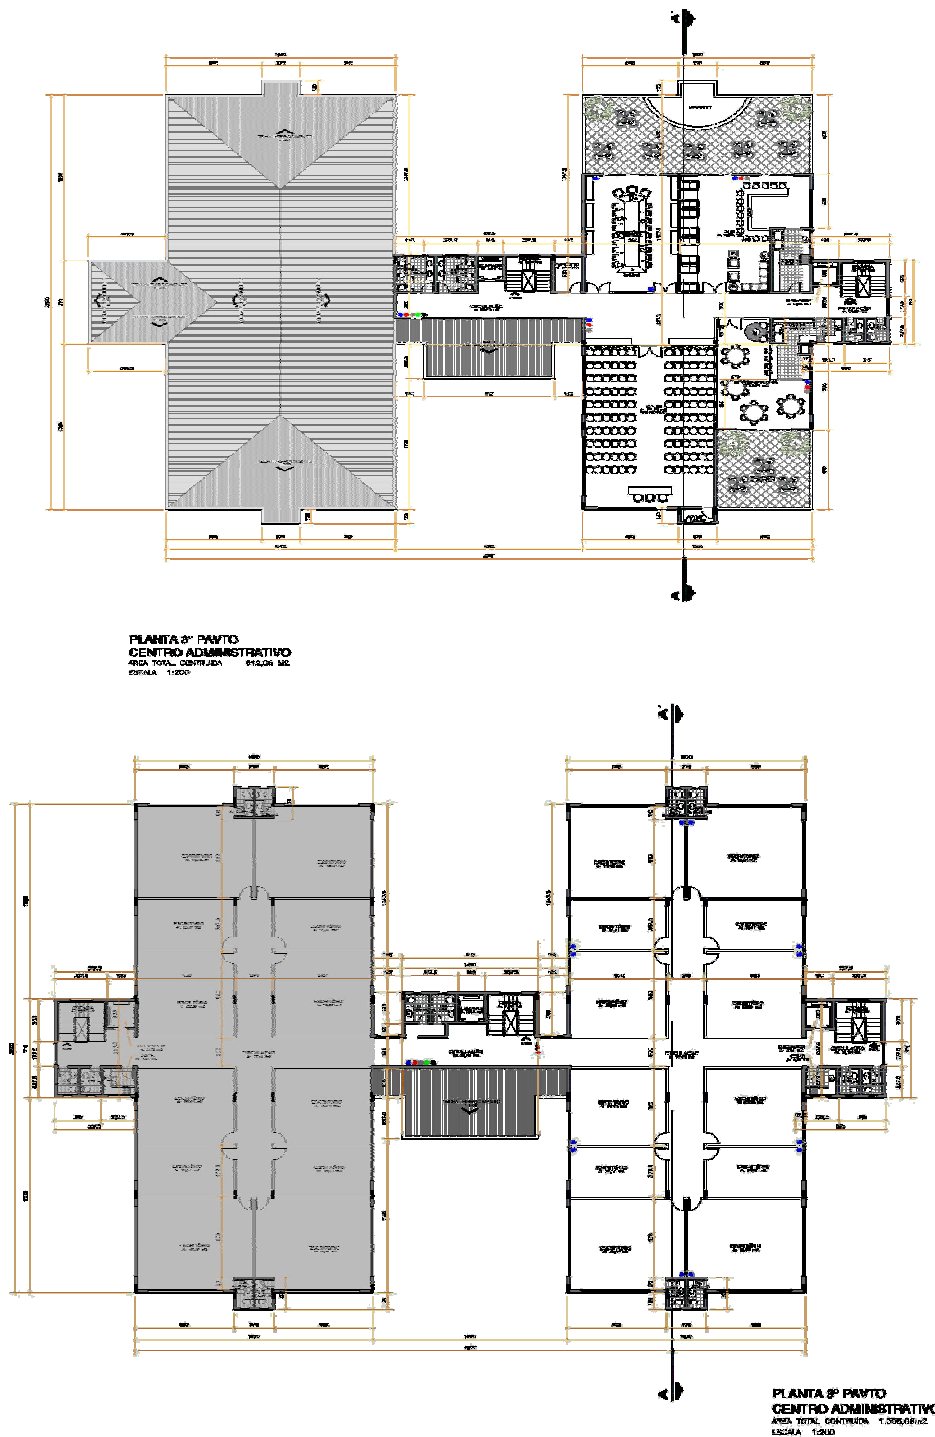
Planta do Centro Administrativo (para detalhamento ver Anexo 2-III Desenhos 06/14)
